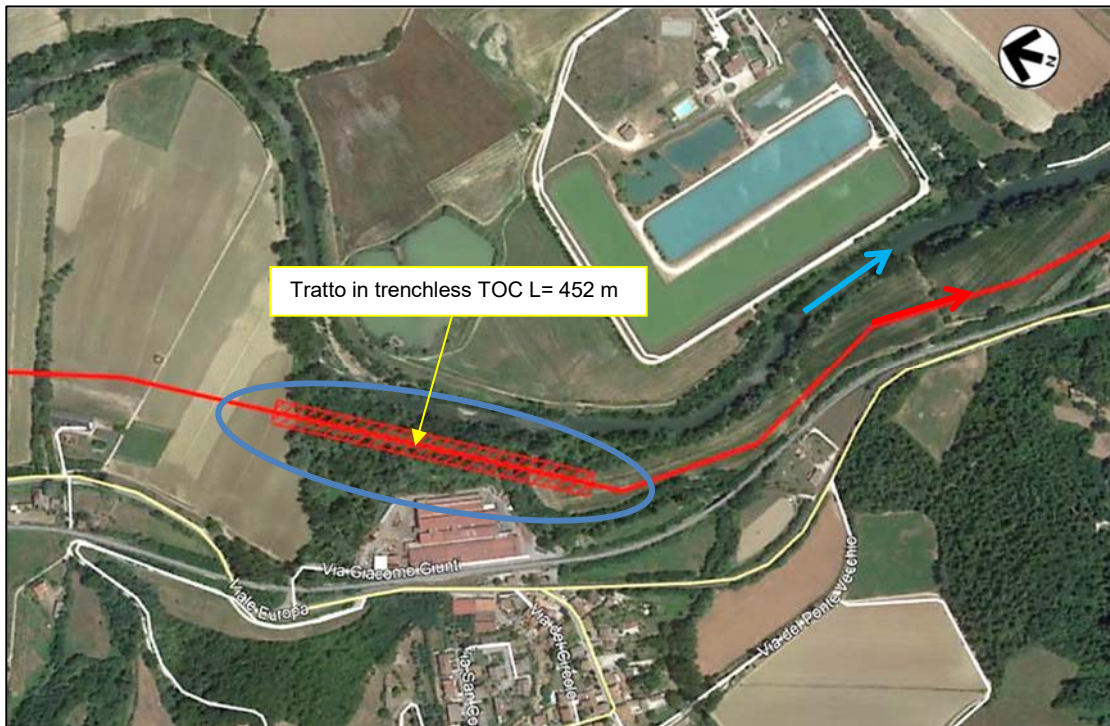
/C – Immagine aerea con localizzazione della sezione di attraversamento
